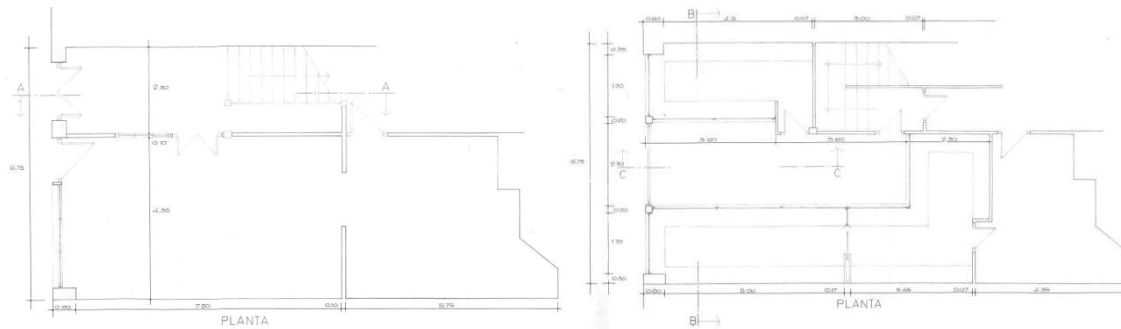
15. 1973. ESTADO ANTERIOR Y POSTERIOR A LA REFORMA DE LA PLANTA BAJA
